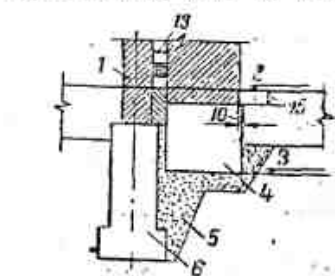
Фундамент под печь, расположенную у кирпичной стены: 1—стена; 2—фундамент под печь, бут; 3—фундамент под стену, бут; 4—уровень, засыпается песком; 5—печь, показана пунктиром.
